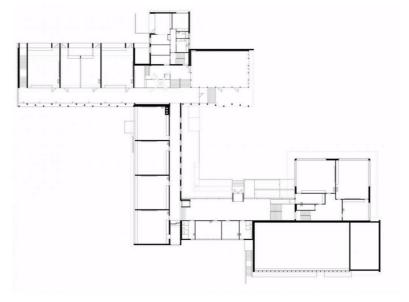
Grundrissplan, freier Massstab; Quelle: www.architekturpreisbeton.ch
